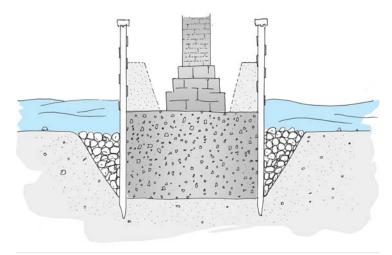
5. Cimentación directa con hormigón sumergido, recinto de pilotes de madera.
